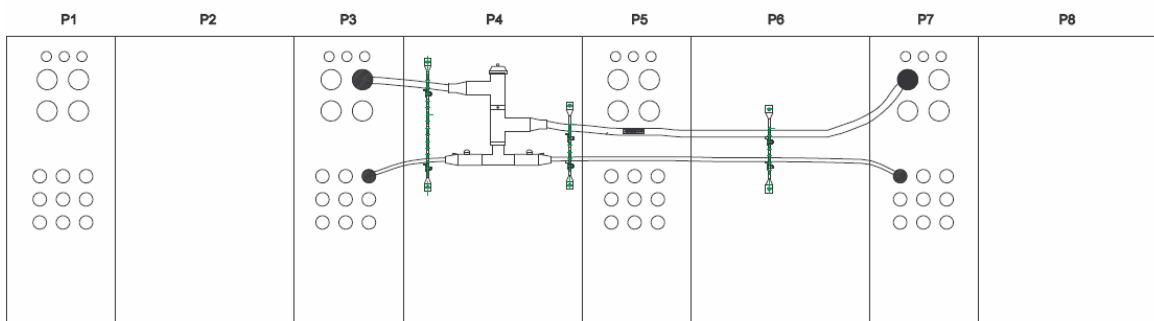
VISTA PLANIFICADA DO POÇO DE INSPEÇÃO [4]
